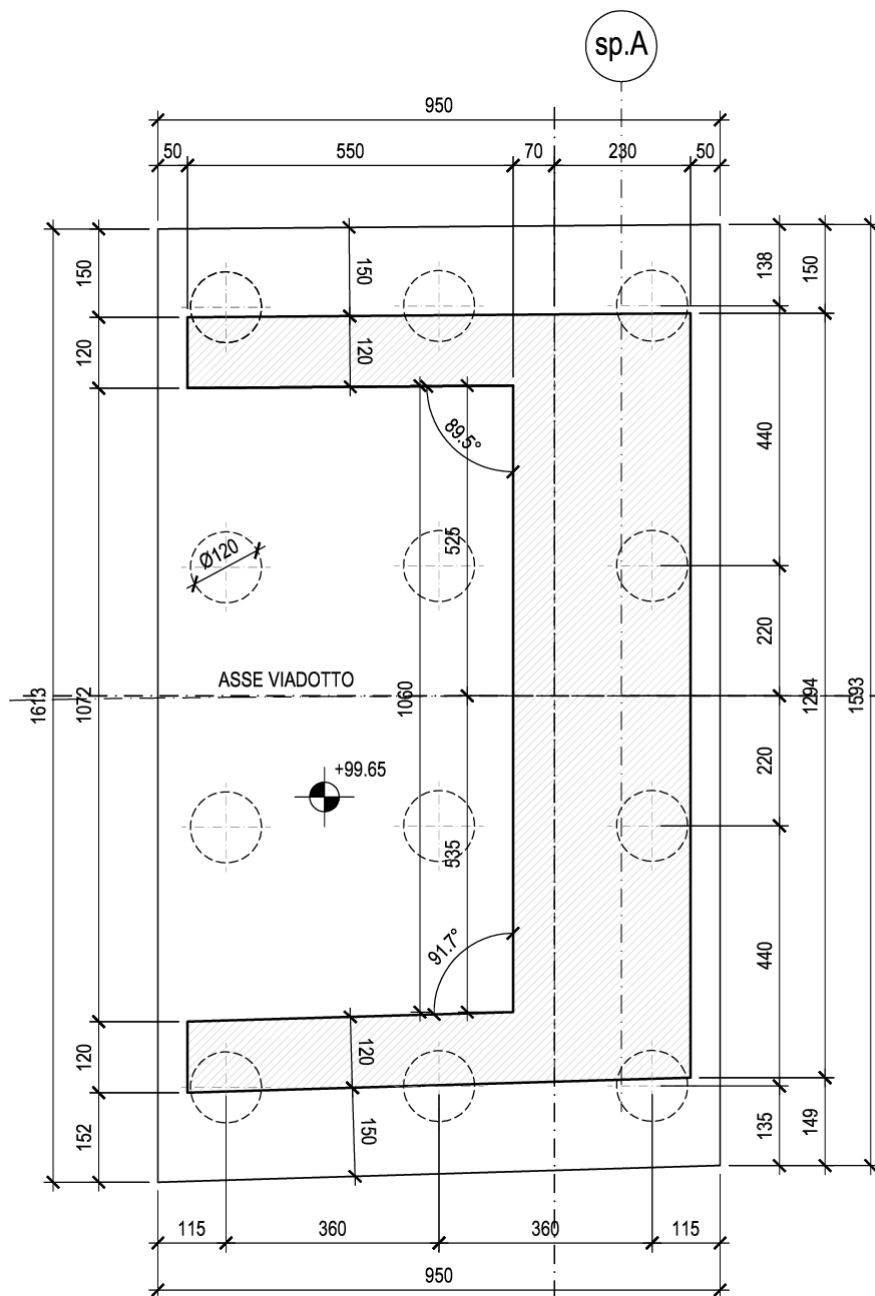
Disposizione planimetrica pali Spalla A.
